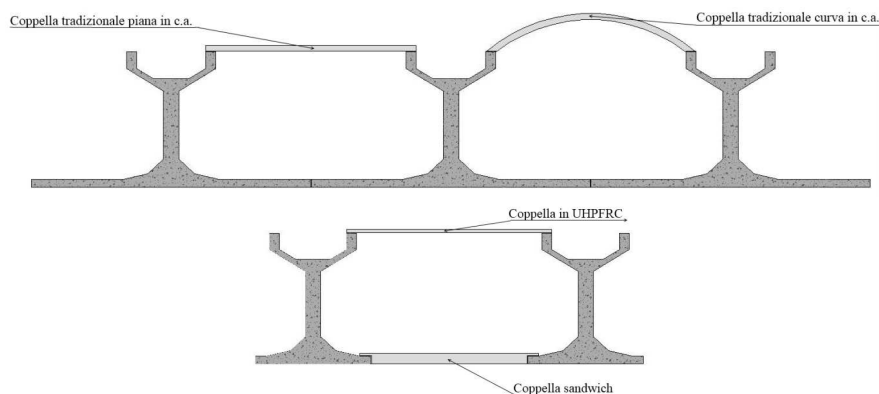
Soluzione tradizionale e alternativa dello schema strutturale Phoenix
